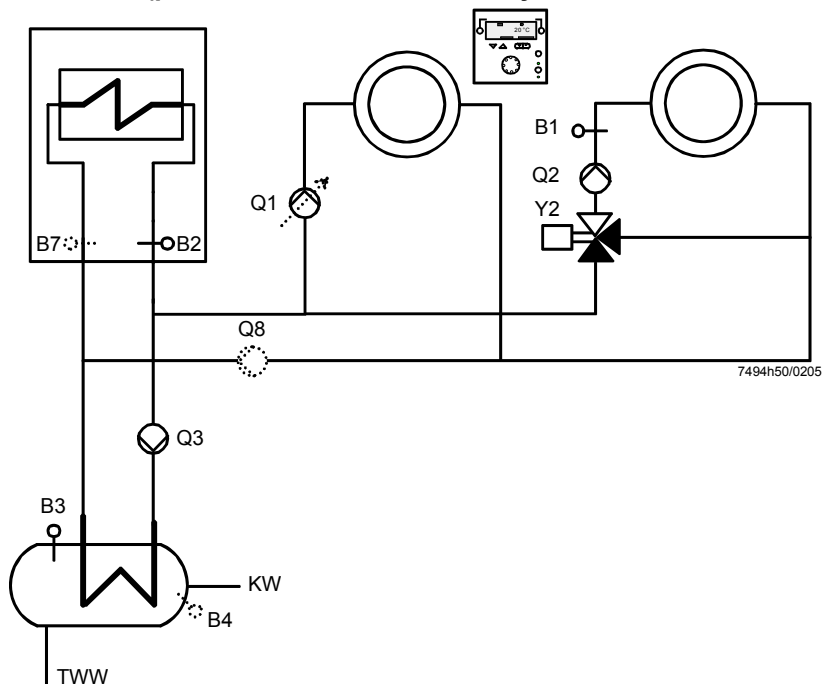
Systém zásobníku s přepouštěcím ventilem a čerpadlovým okruhem
